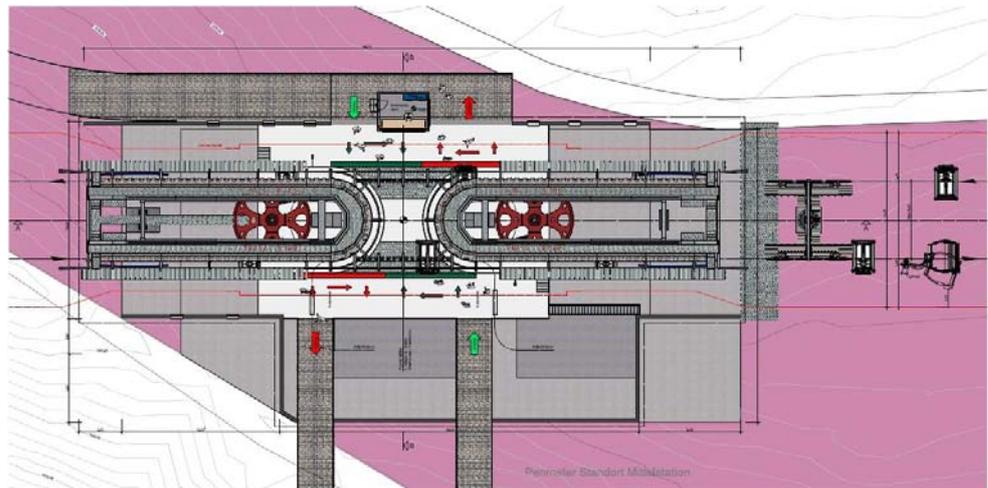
Beispiel Grundriss einer Mittelstation mit Kellergaragierung
